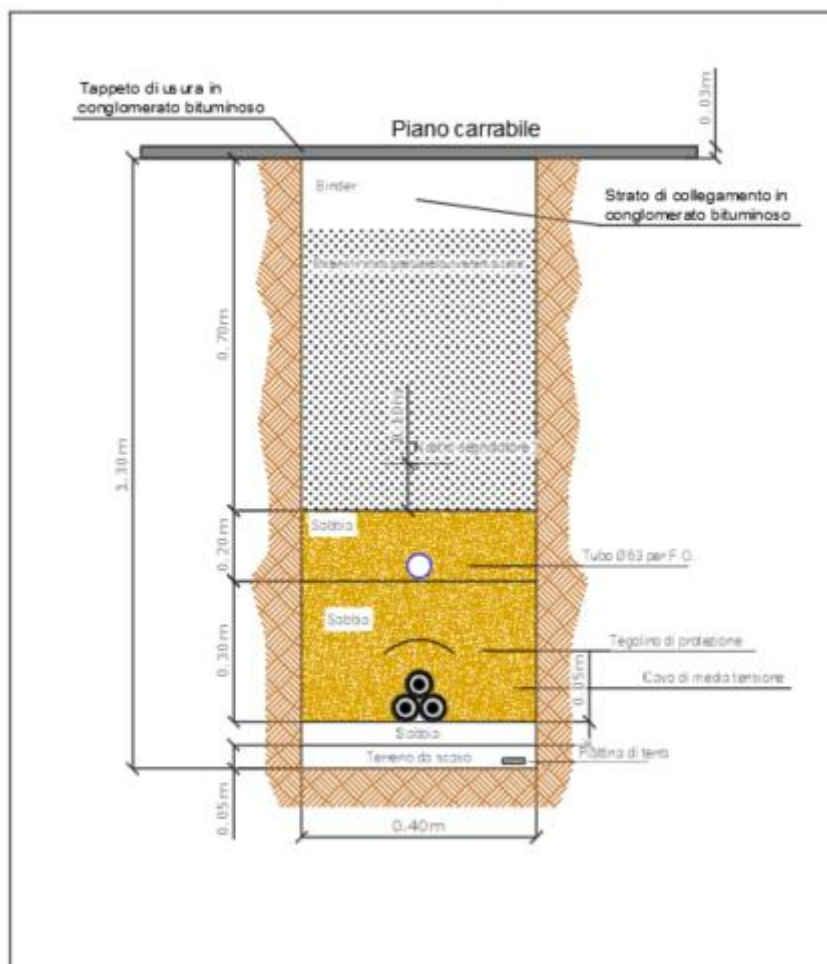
Attraversamento Tipo – Strada Asfaltata
